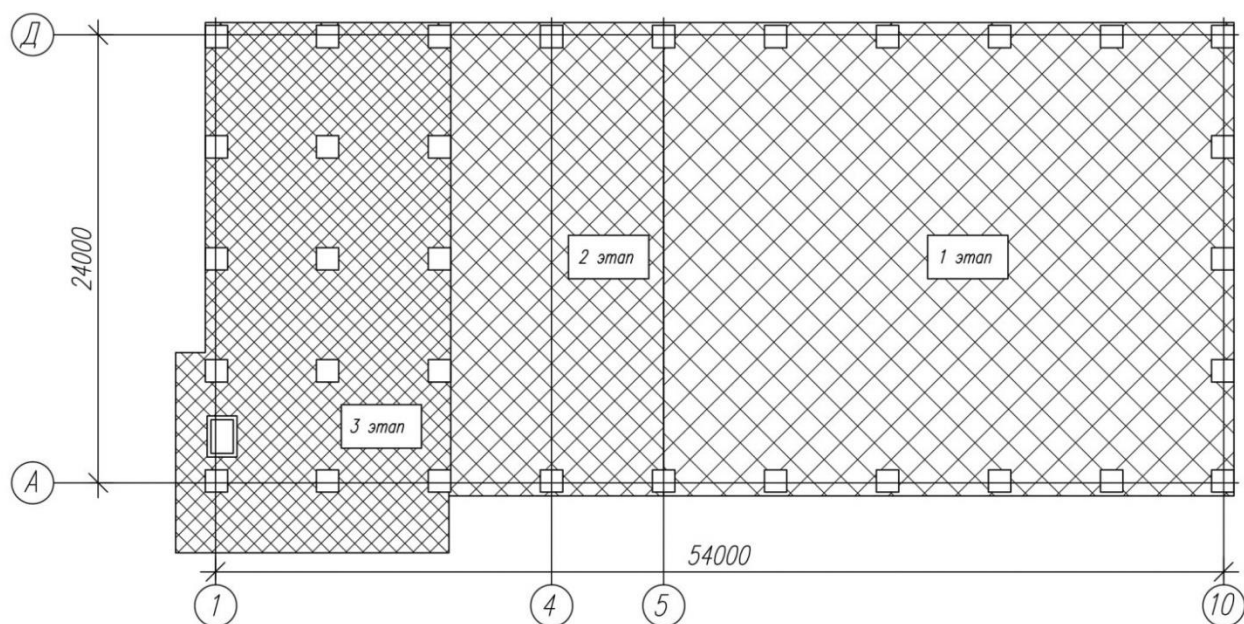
Общая схема устройства подбетонки под фундаментную плиту
